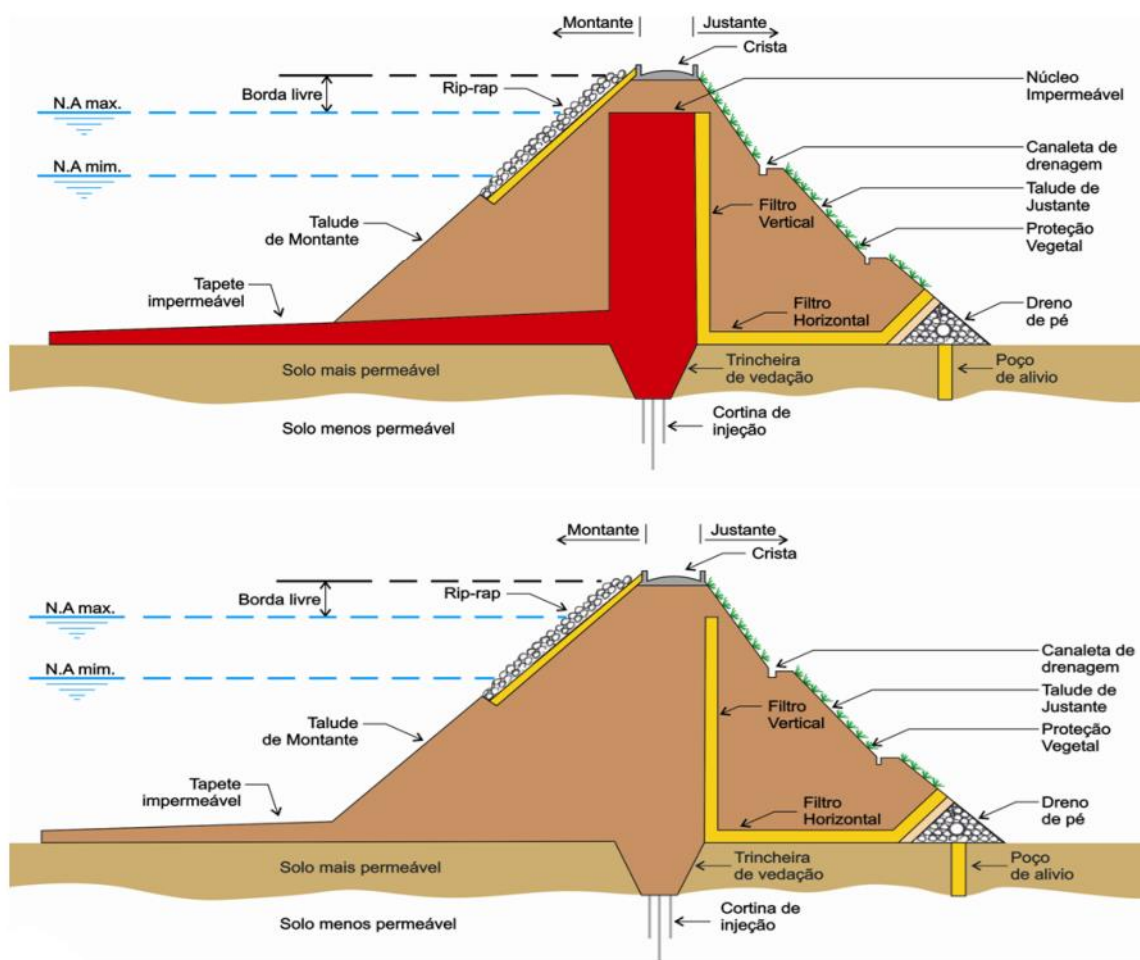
Tipos de barragens e elementos construtivos (Fonte: Prof. David de Carvalho - UNICAMP– SP)
